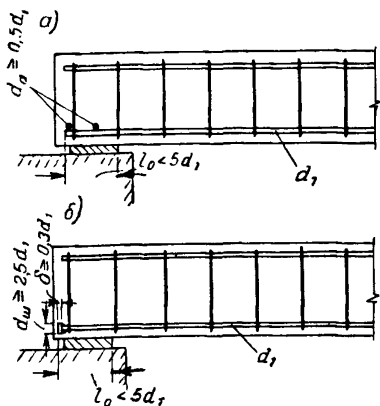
Анкеровка продольной рабочей арматуры на свободных опорах балок в случаях, когда поперечная арматура по расчету не требуется, т. е. когда  $\frac{Q}{mbh_0} < R_p$ ,
